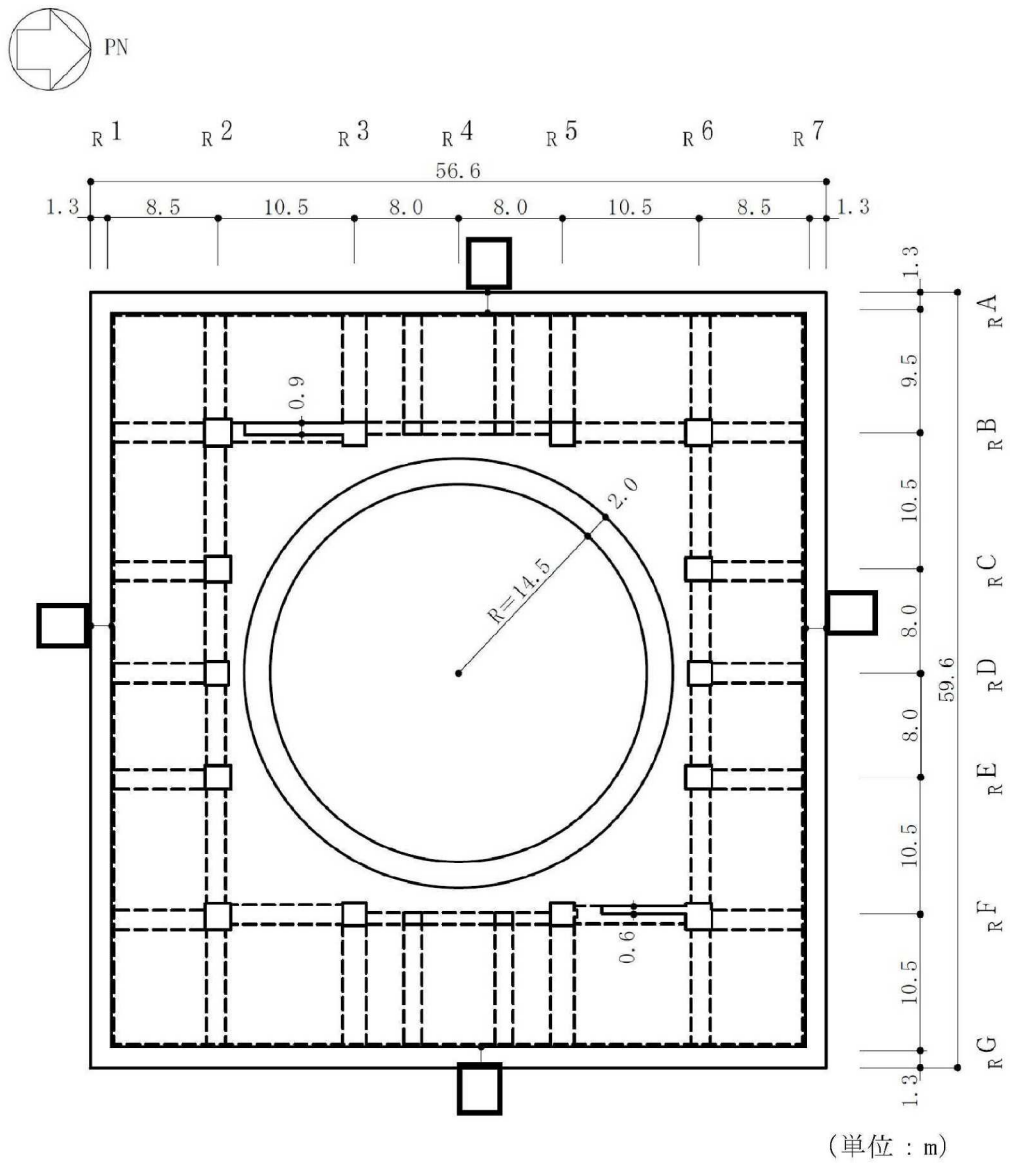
原子炉建屋の概略平面図 (B2F, T.M.S.L. -1.7m) (2/9)
